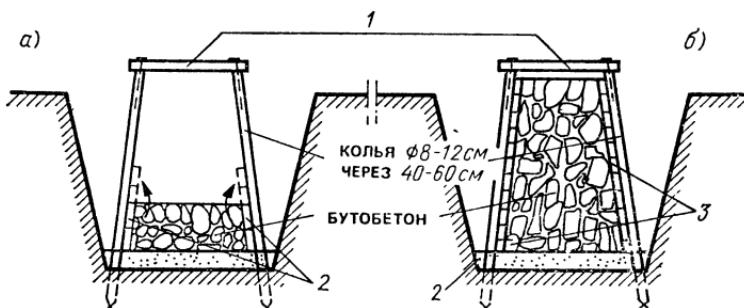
Схема устройства опалубки для бутобетонных фундаментов при бетонировании по слоям (а), на всю высоту (б)
